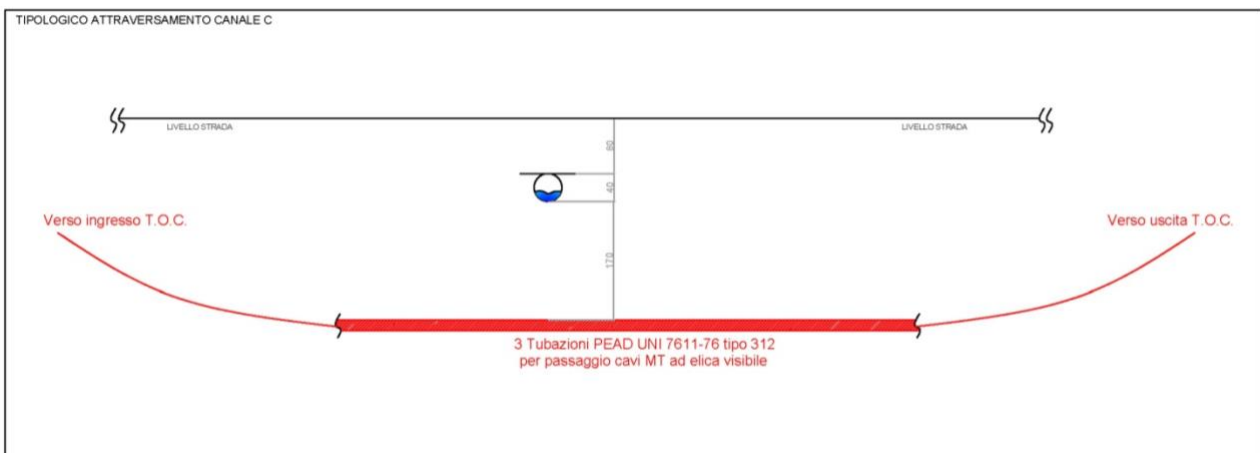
Dettaglio attraversamento in T.O.C. canale C
